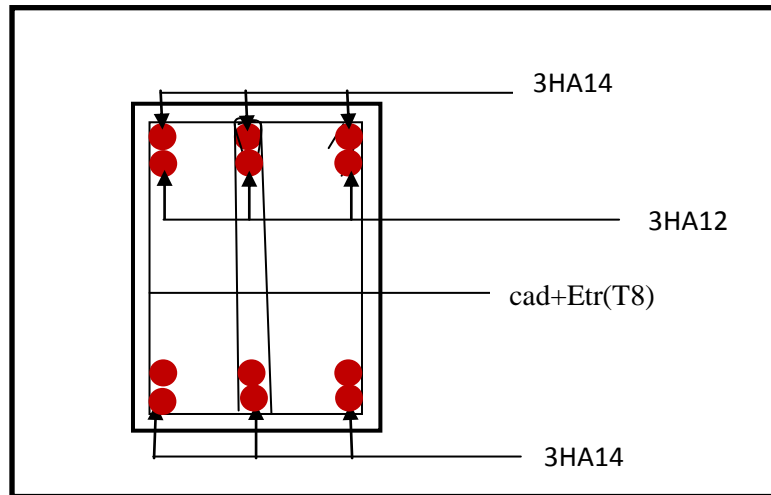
Ferraillage sur appuis d'une poutre secondaire.
